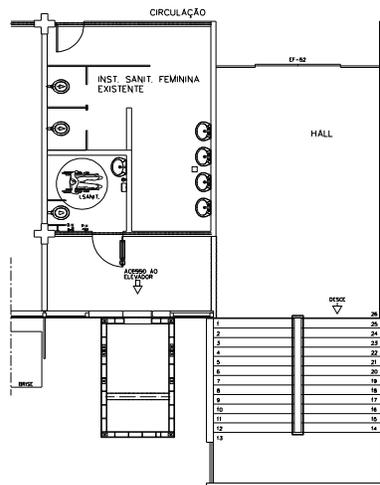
Planta elevador e sanitário para deficientes, 2º pavimento
